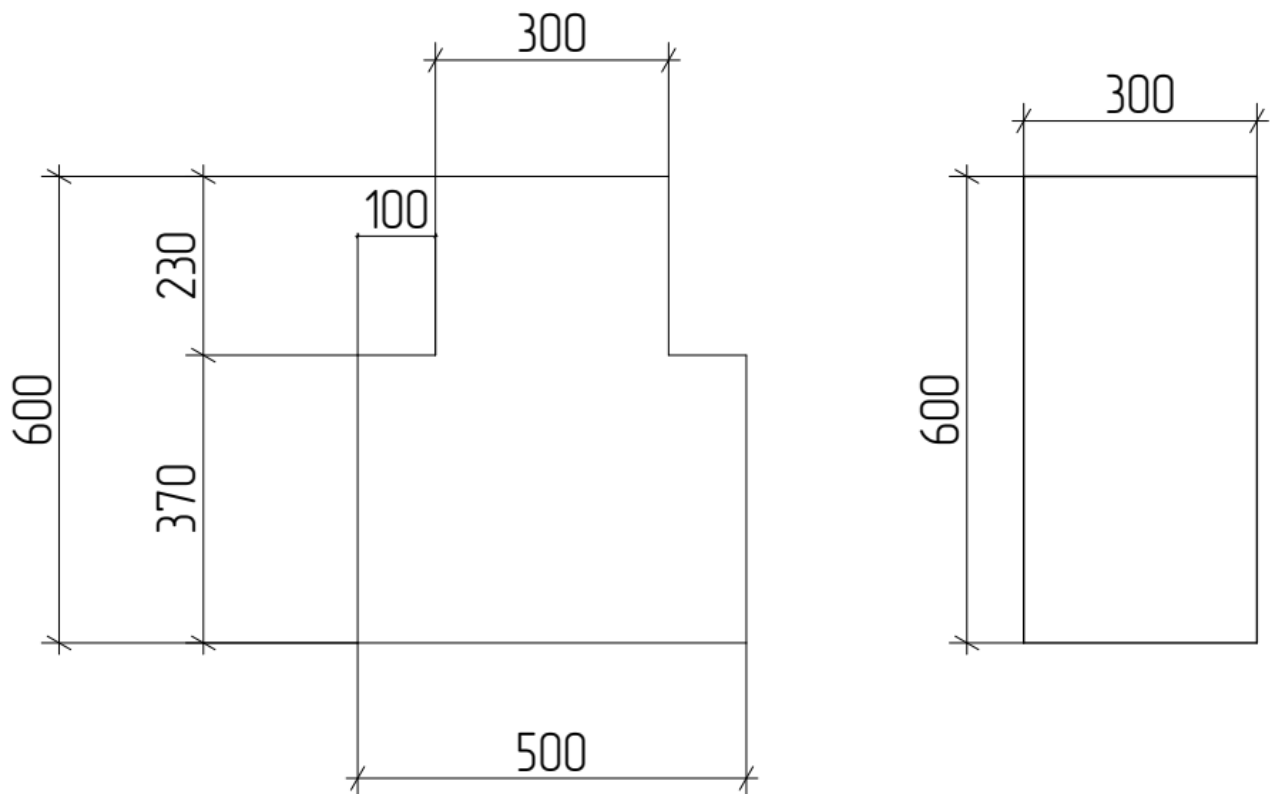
Поперечний переріз ригеля громадської будівлі: а) фактичний; б) розрахунковий
